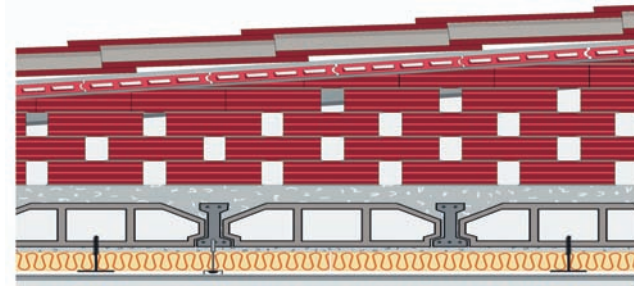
Cubierta de teja sobre faldón apoyado sobre tabiquillos (espacio no habitable) y forjado horizontal.
